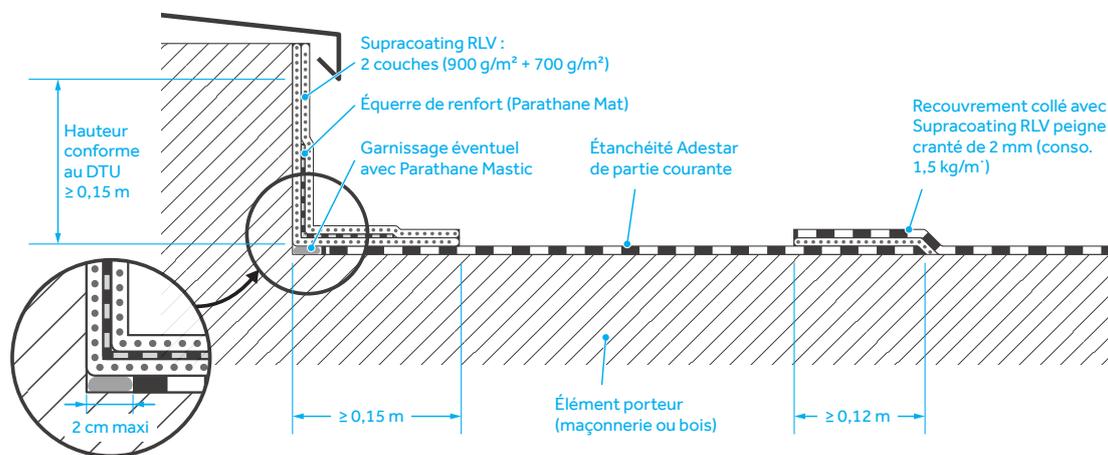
Revêtement Adestar sous protection lourde en toiture inaccessible sur élément porteur en maçonnerie ou en bois
